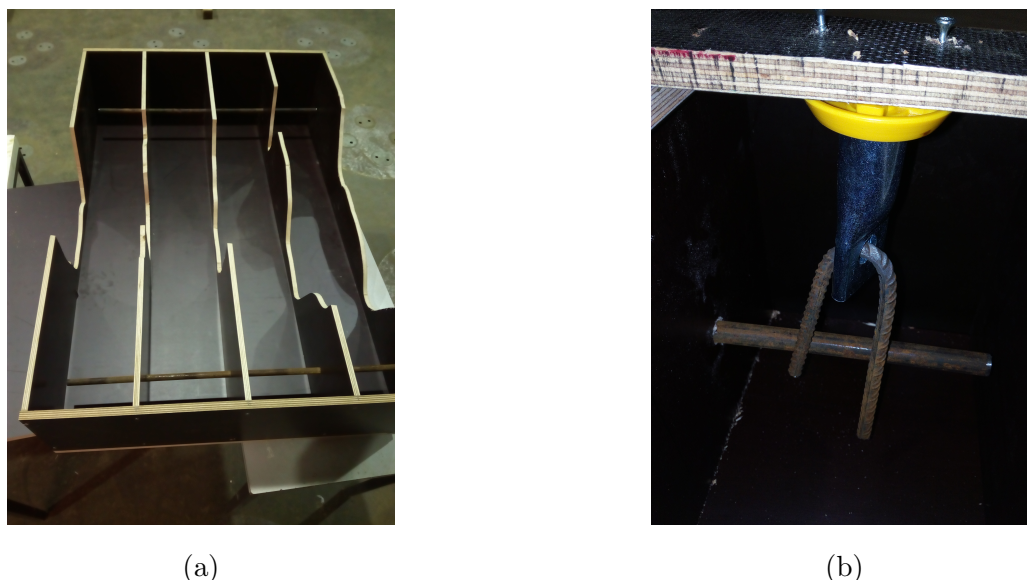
(a) Exemple d'un module de coffrage avec armatures longitudinales (b) Détail de l'armature longitudinale avec la douille de levage et son étrier
